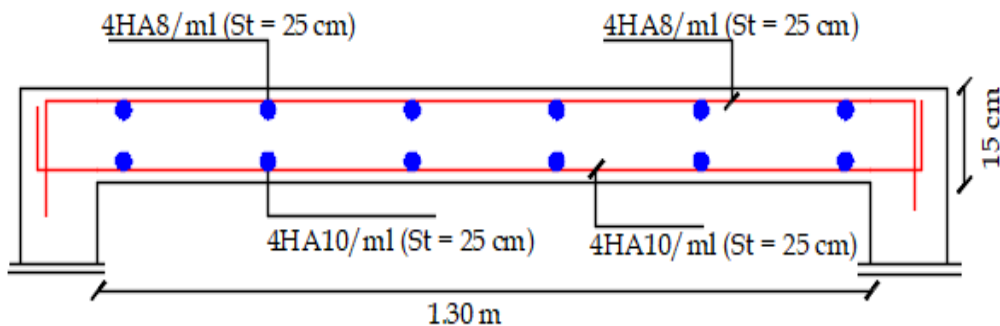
schéma de ferrillage de dalle salle machine sens (X-X) et (Y-Y)
